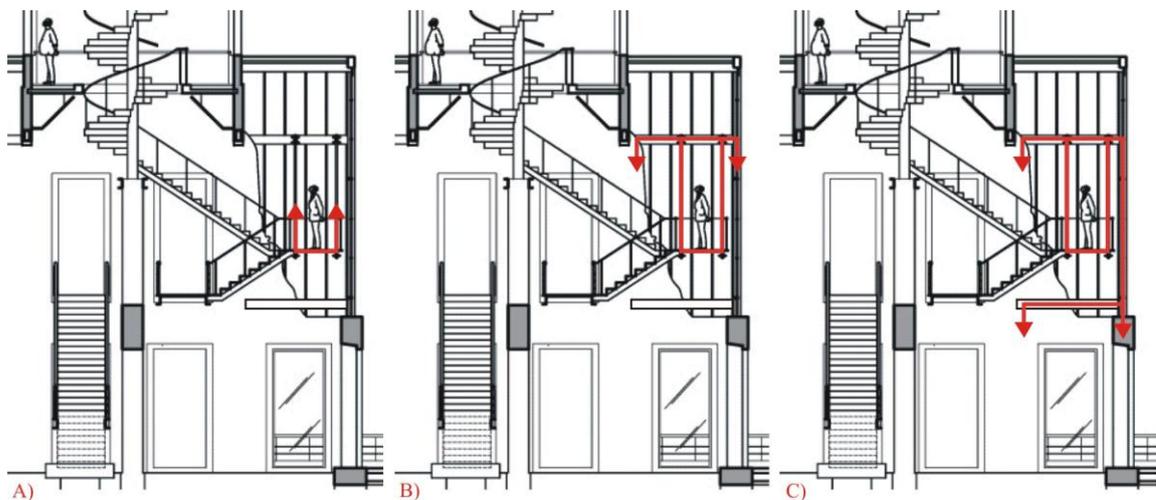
Corte transversal parcial: Caminho das cargas no patamar atirantado.
